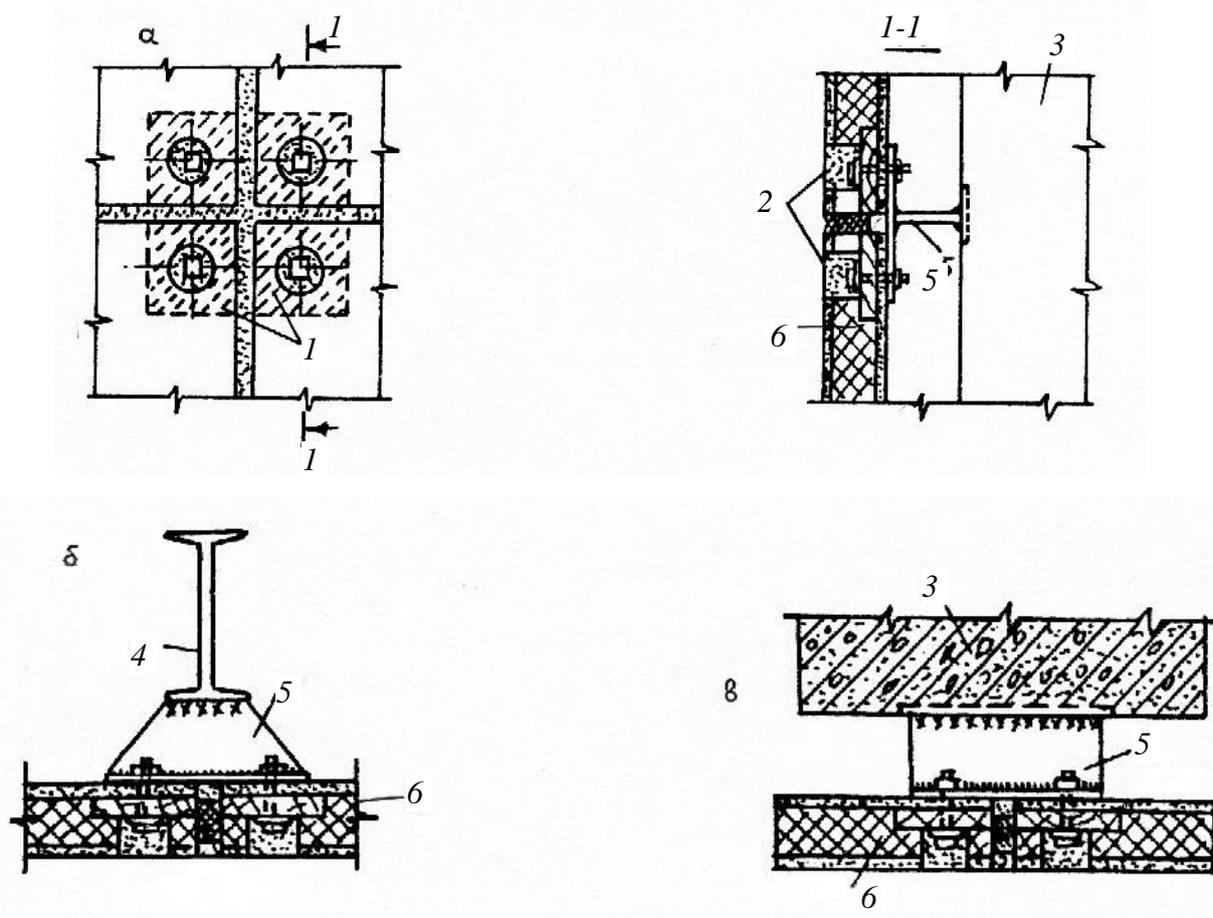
Крепление легкобрасываемых стеновых панелей к каркасу здания на болтах:
